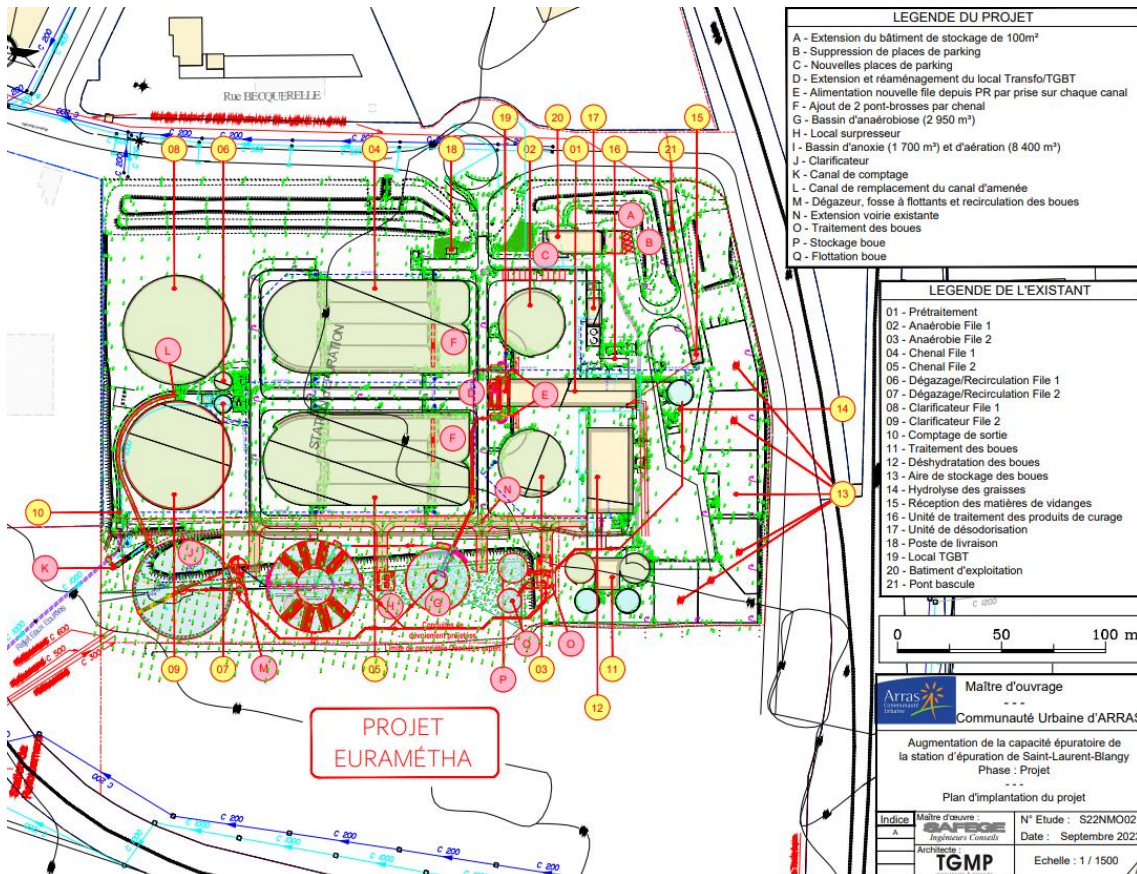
Localisation des ouvrages à construire (Source : Safège, 2025)
